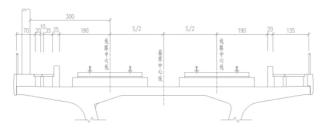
无砟轨道双线梁桥面布置示意图 (单位: cm)
